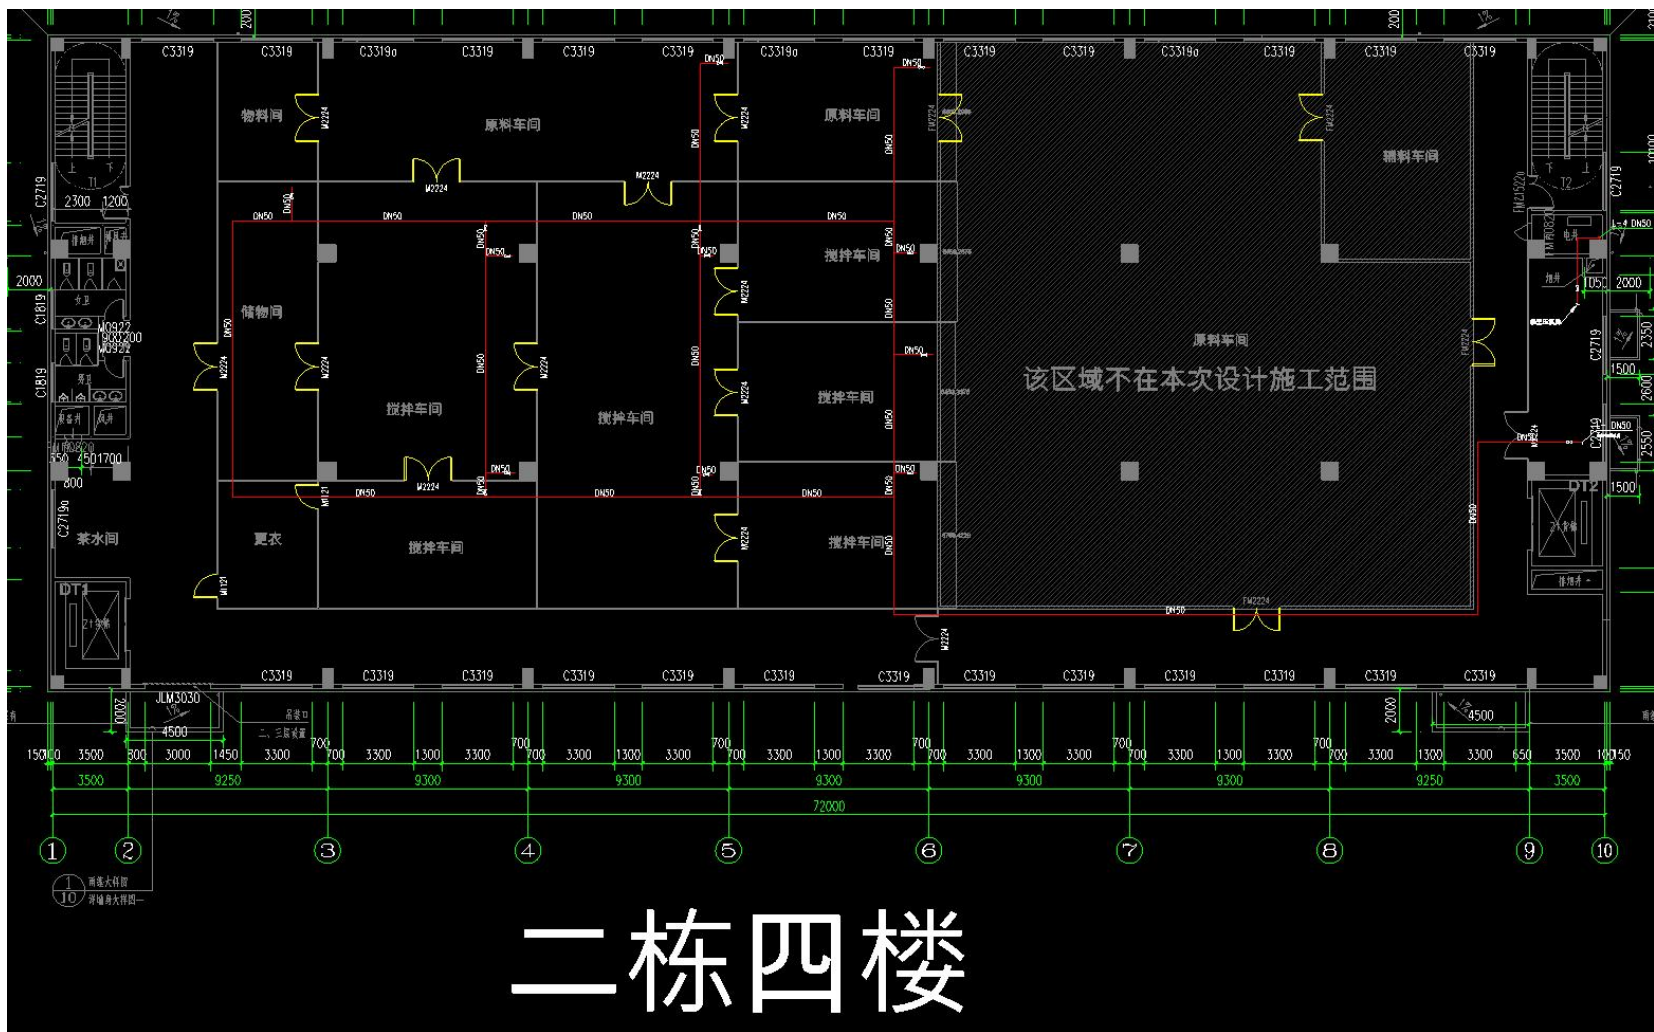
项目总平面布置图 (2 栋 4 层)
